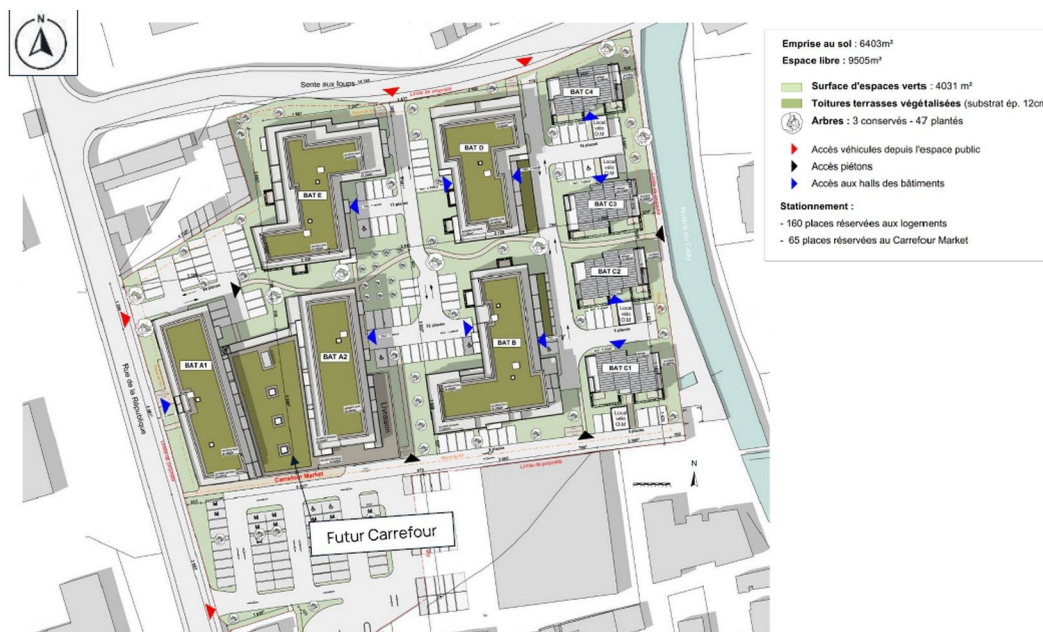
plan de masse du projet (p. 379 de l'étude d'impact – EI)
